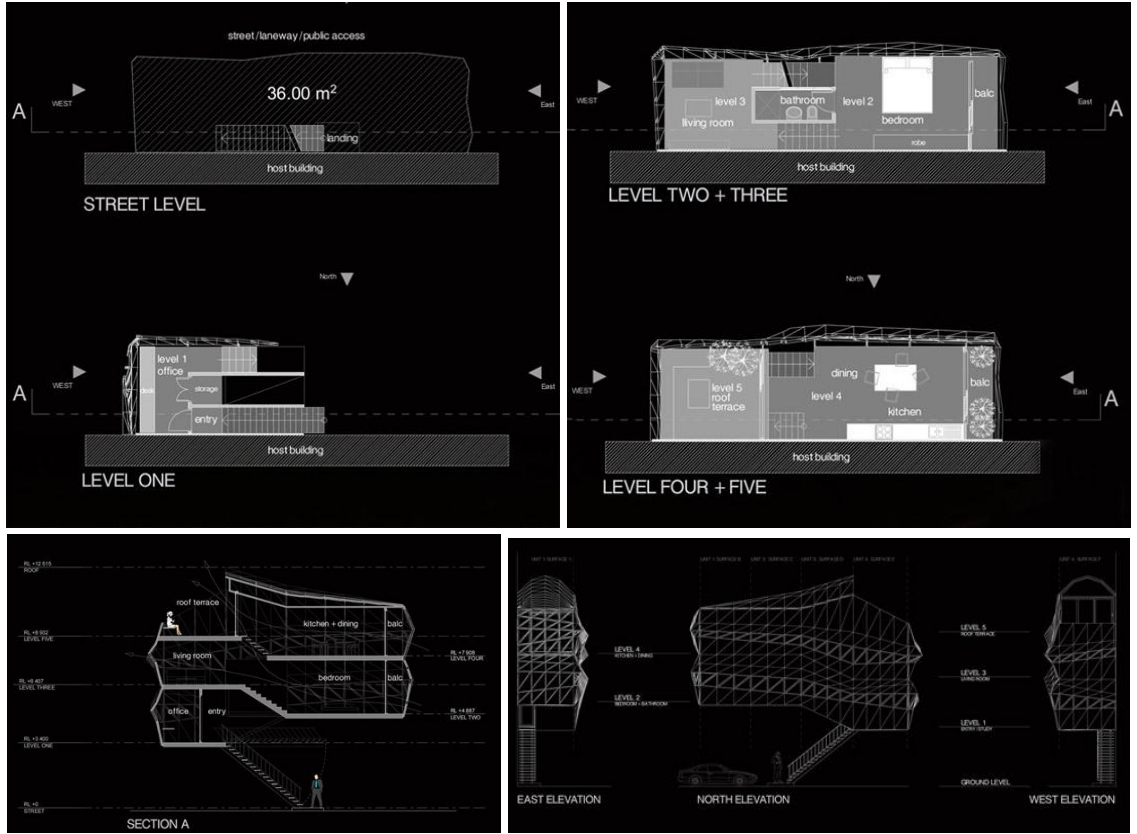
Prefab Parasite'a ait fotoğraflar (ArchDaily, 2009b)
